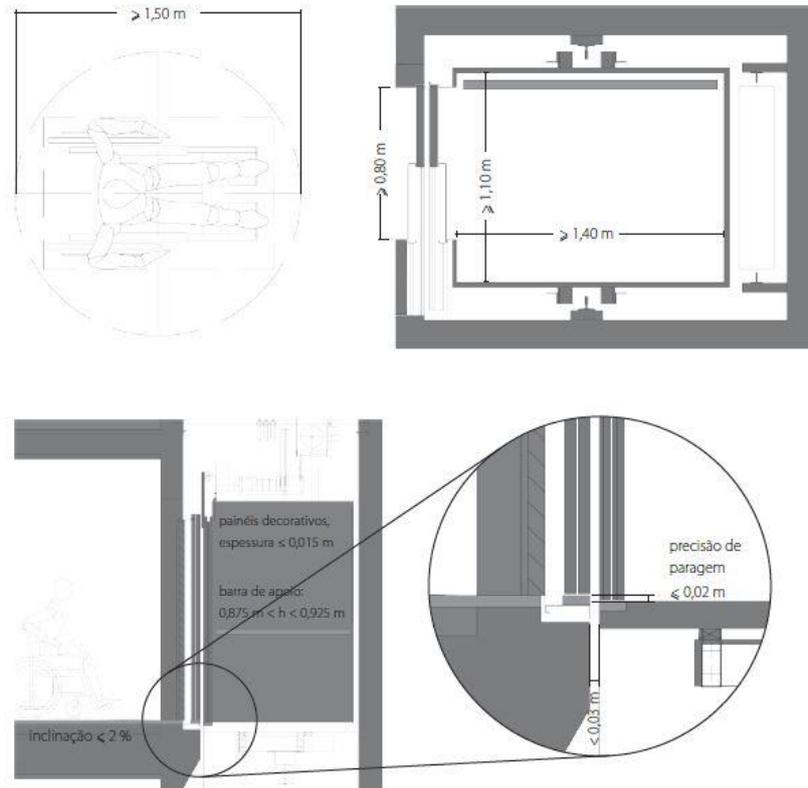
Detalhas construtivos de dispositivos mecânicos de elevação (Teles, 2007, p. 113)
